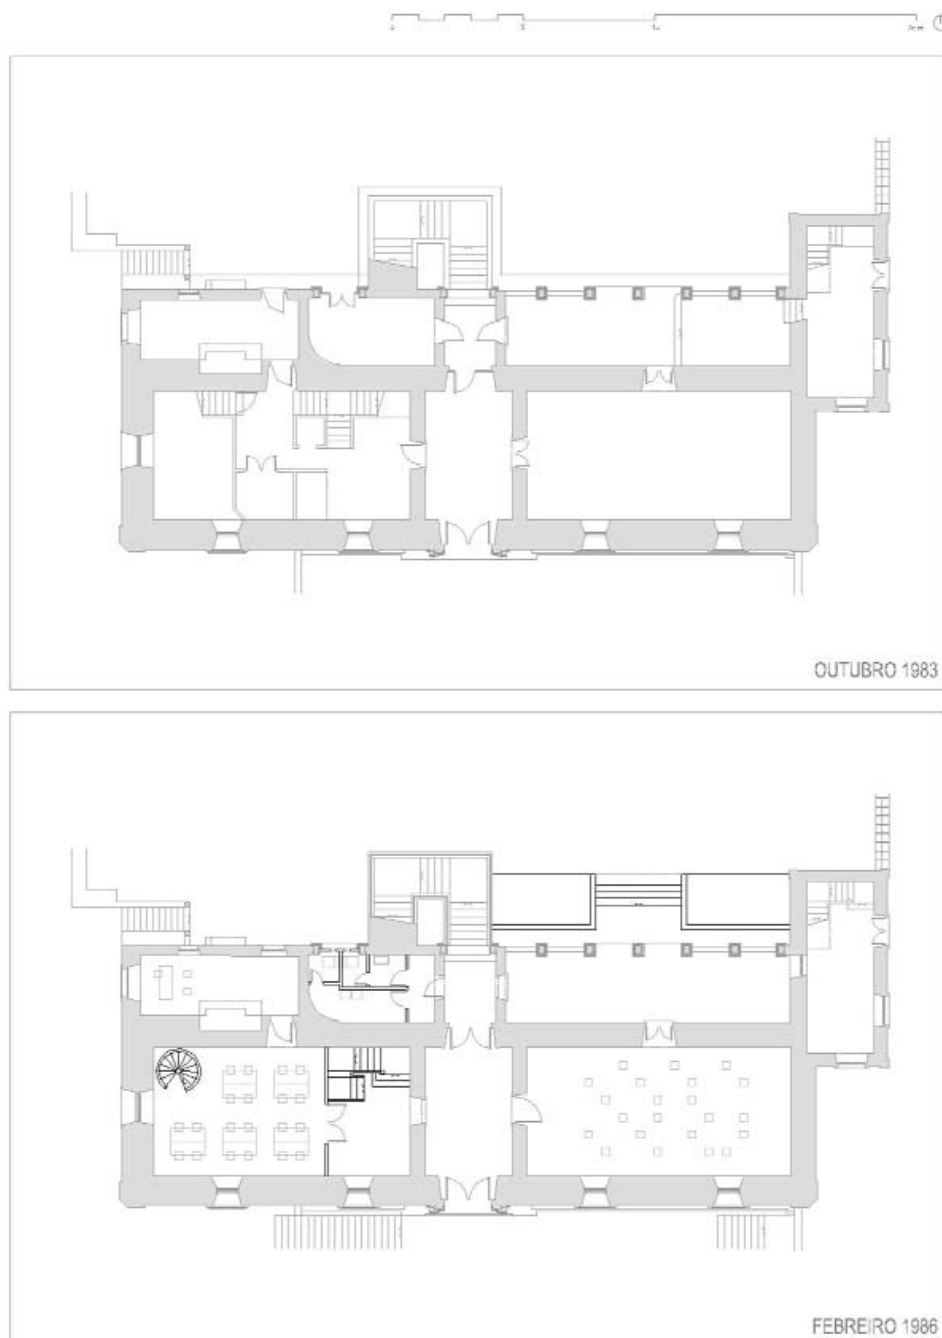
SANTO AGOSTIÑO. Planta baixa.
